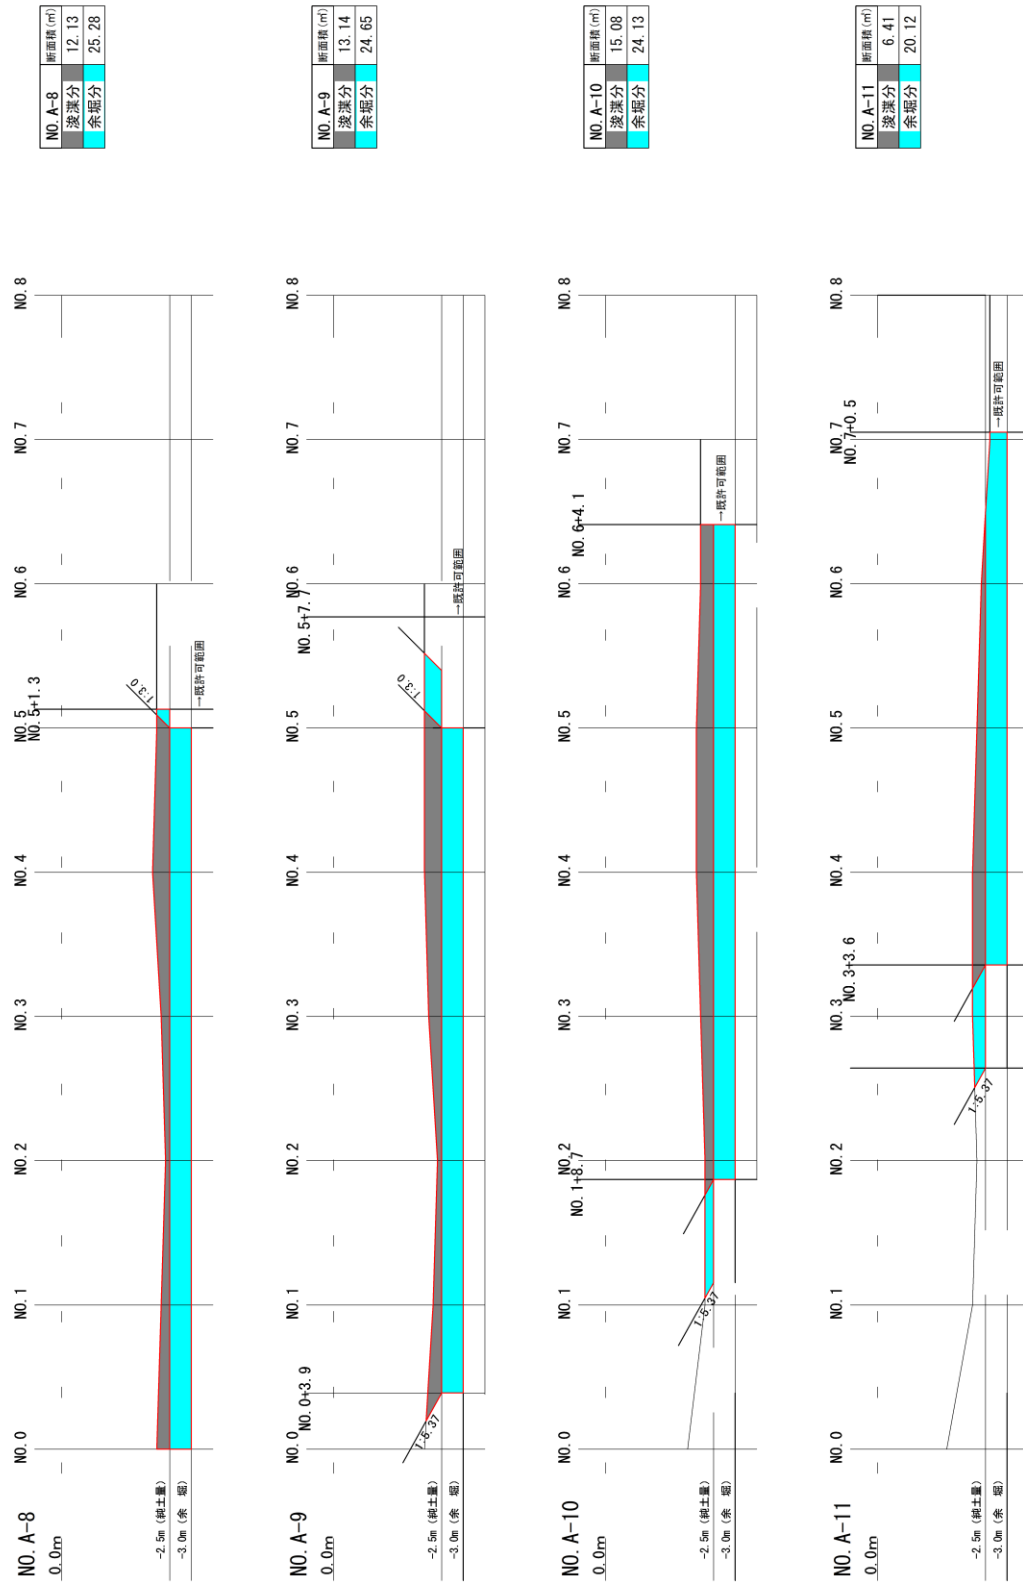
(3) 横断面図 (測線 No. A-8~A-11)
